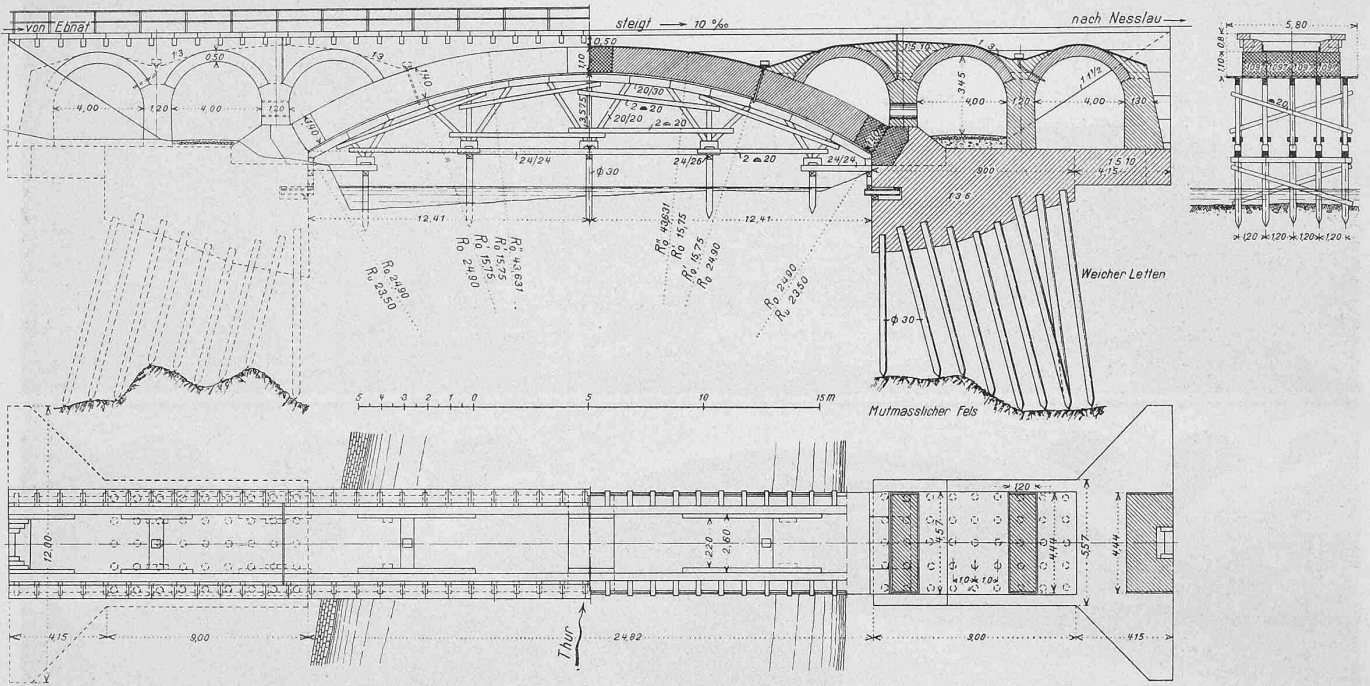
Steinernen Thurbrücke bei Km. 6,650. — Ansicht, Grundriss und Schnitte. — Masstab 1 : 300.
